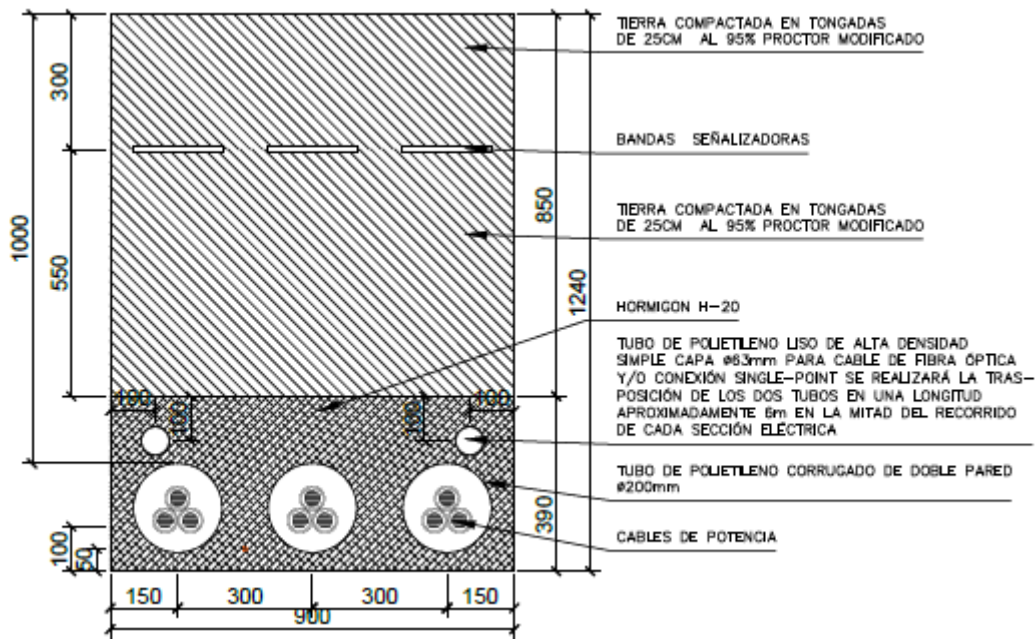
Canalización Hormigonada cruce bajo Arroyos
